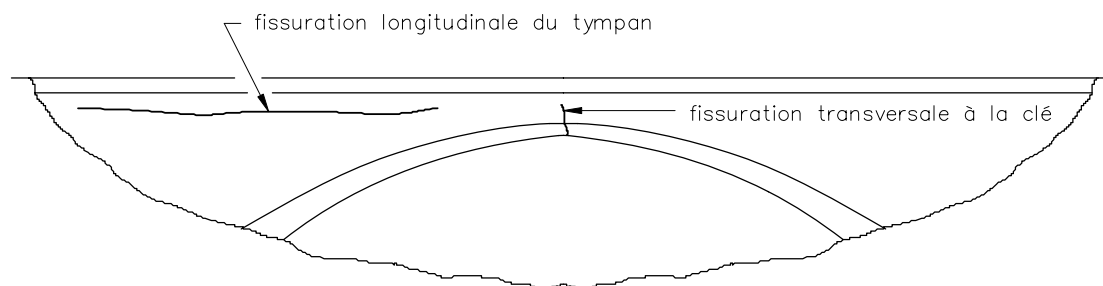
Fissuration d'un arc en béton
